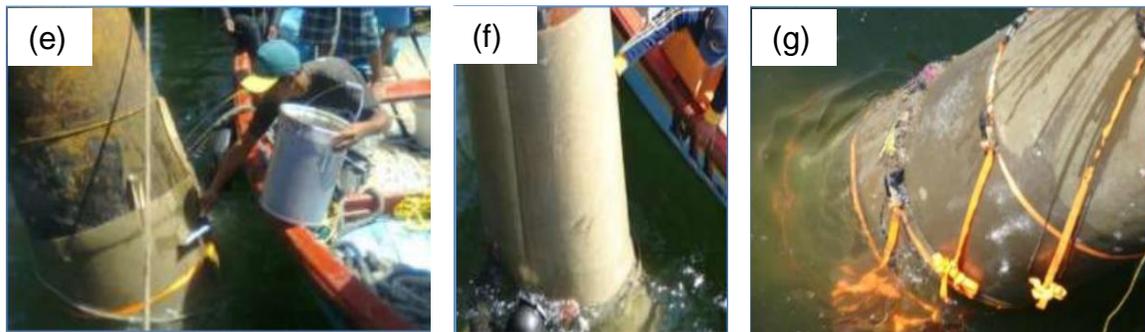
Últimos pasos para la aplicación de la protección. (e) Vaciado de *grout* en chaqueta, (f) Colocación de la chaqueta superior, (g) Pilote con sistema FX – 70 aplicado
